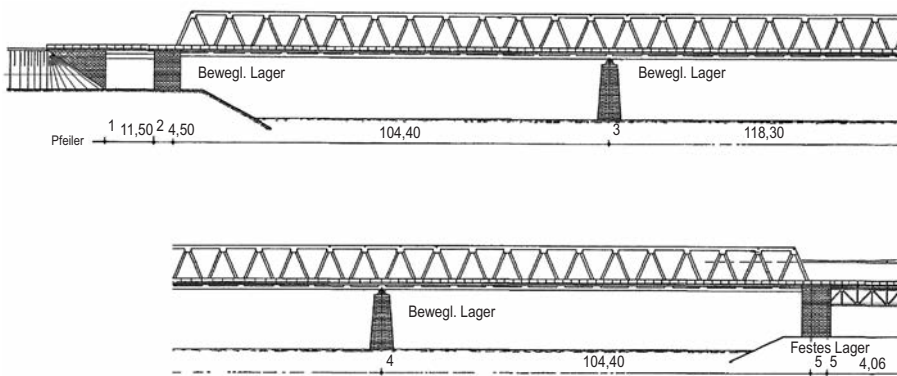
Längsschnitt bestehendes Bauwerk Rheinbrücke (Abbildung: privat)
